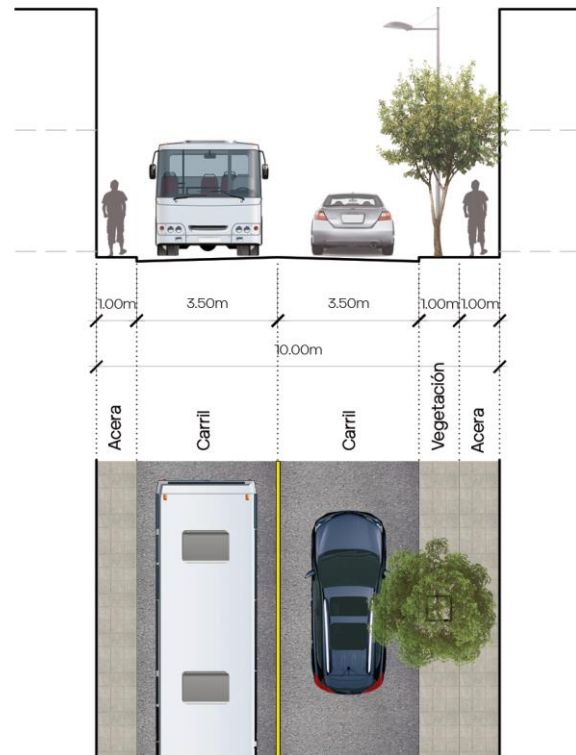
Sección transversal propuesta de la arteria primaria de la red periférica.
